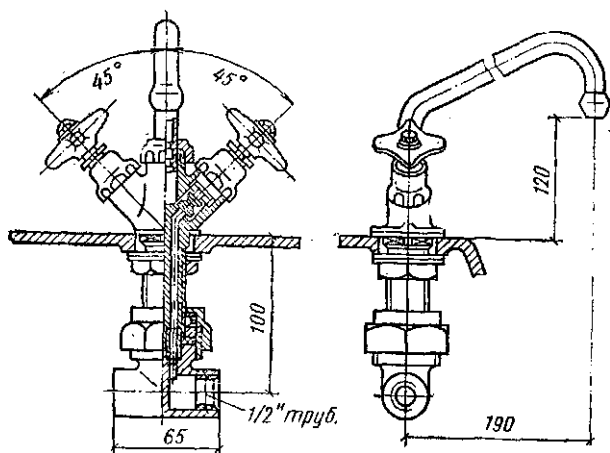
Смеситель для мойки центральный См-М-ВКСЦ
